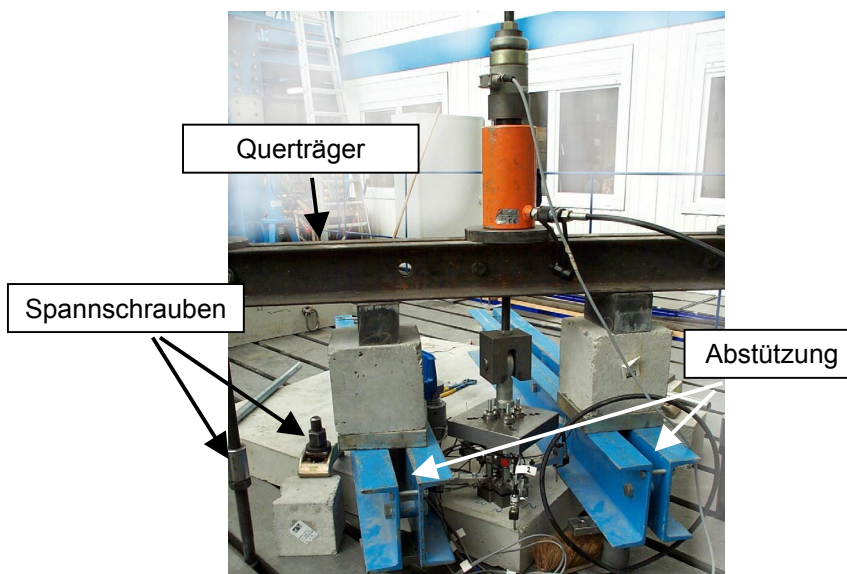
Belastungseinrichtung für zentrische Ausziehversuche mit Dübelgruppen in der Ecke im ungerissenen Beton.
